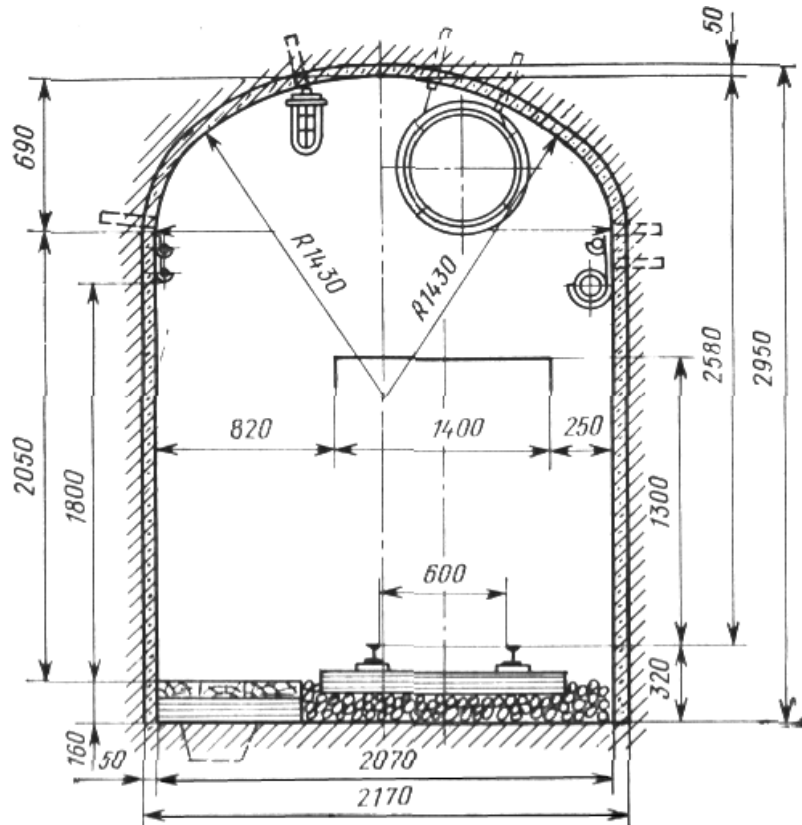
Типовое сечение прямоугольно-сводчатой формы выработки с набрызгбетонной крепью
